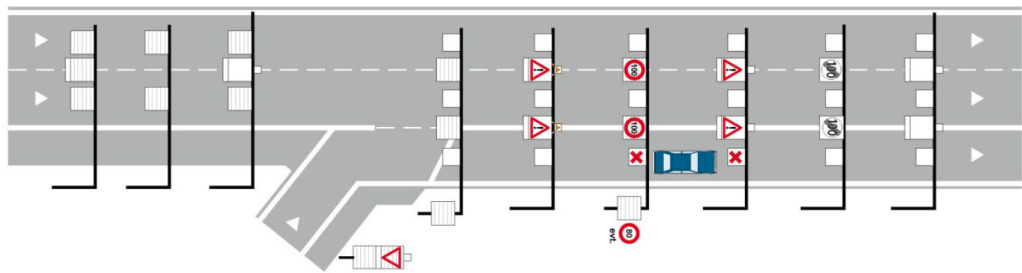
33.3 BAU fermée : événement sur la BAU.
